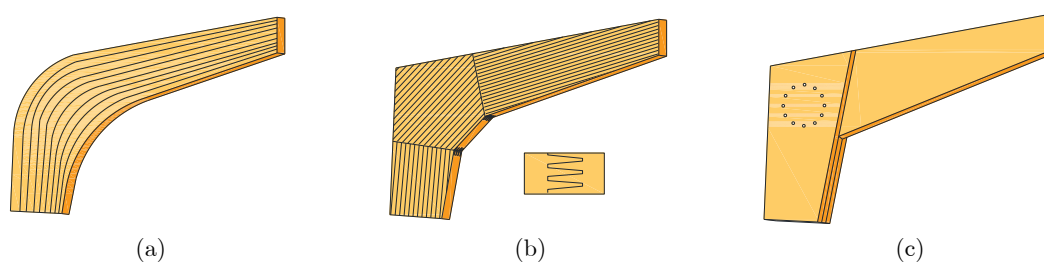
Ligações viga com pilar de lamelados colados.
